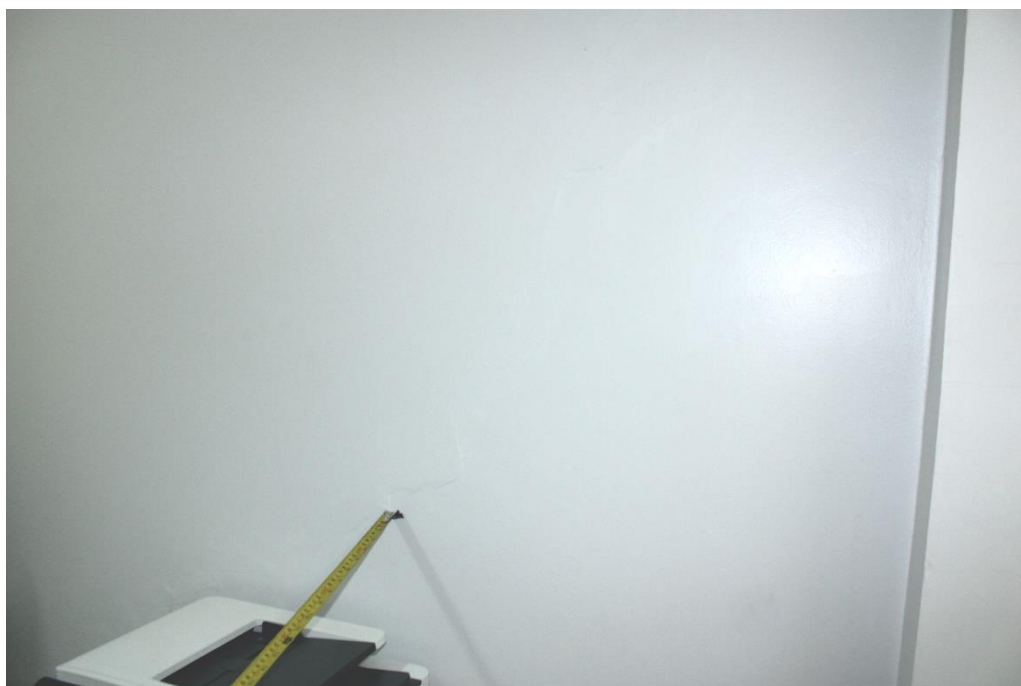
Em detalhe a Foto supra, destacando sinais de reparos em fissuras primitivas.
